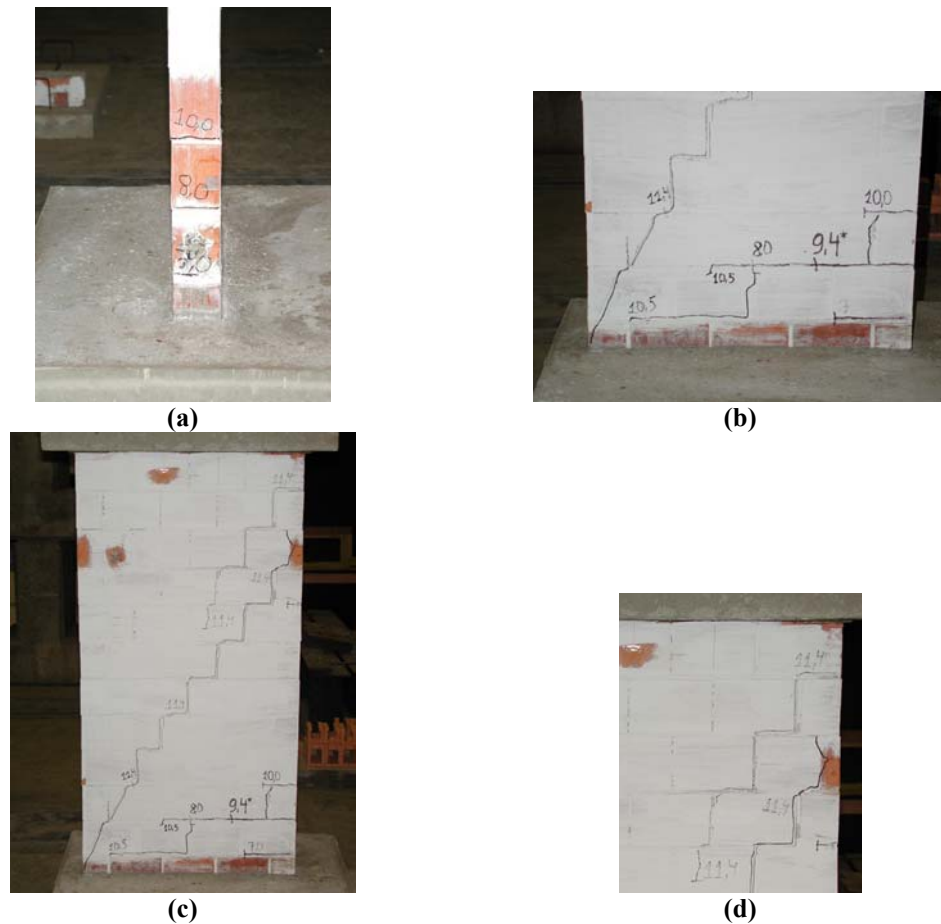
Fissuração ocorrida durante ensaio do modelo PICG1: (a) Detalhe do canto tracionado; (b) Detalhe da fissuração na base; (c) Vista geral do modelo após ruptura e (d) Detalhe da fissuração diagonal em região próxima ao topo.
